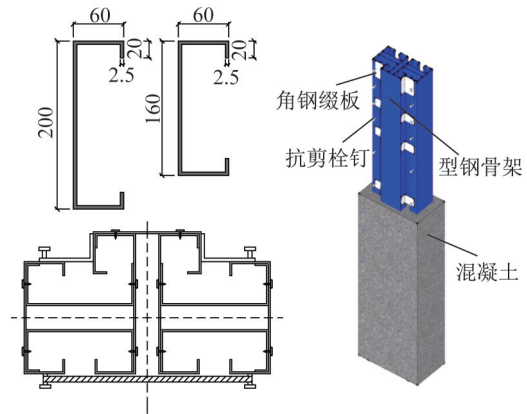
T形轻钢混凝土组合异形柱截面形式及构造(单位:mm)
